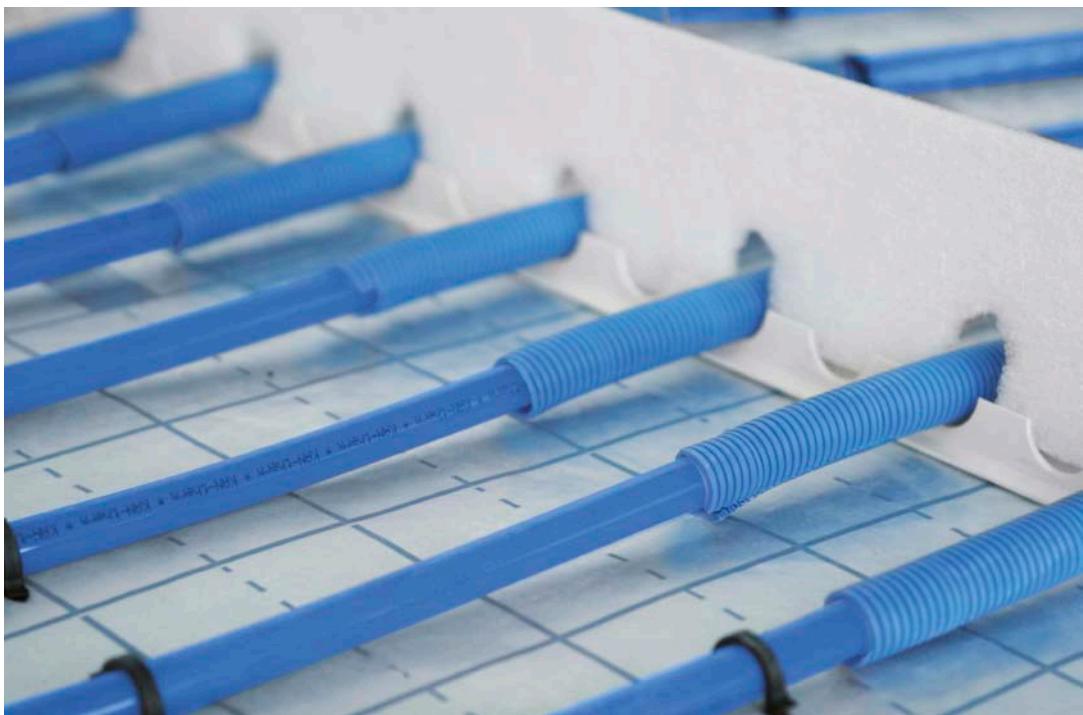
Принцип выполнения разделительных швов в греющих плитах напольного отопления
